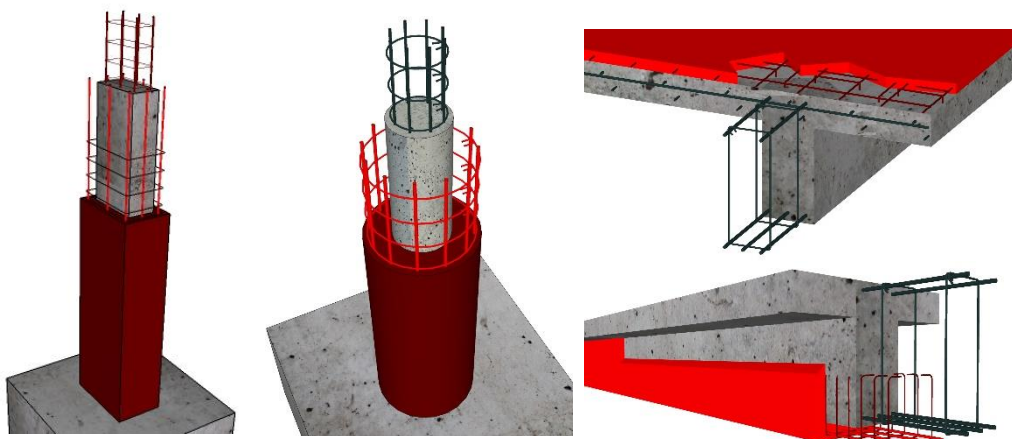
Pormenores do reforço com adição de betão e armaduras em pilares, lajes e vigas [26].
